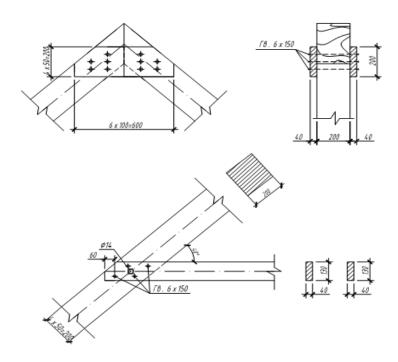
Узлы соединения верхнего пояса арки и ригеля с ним
